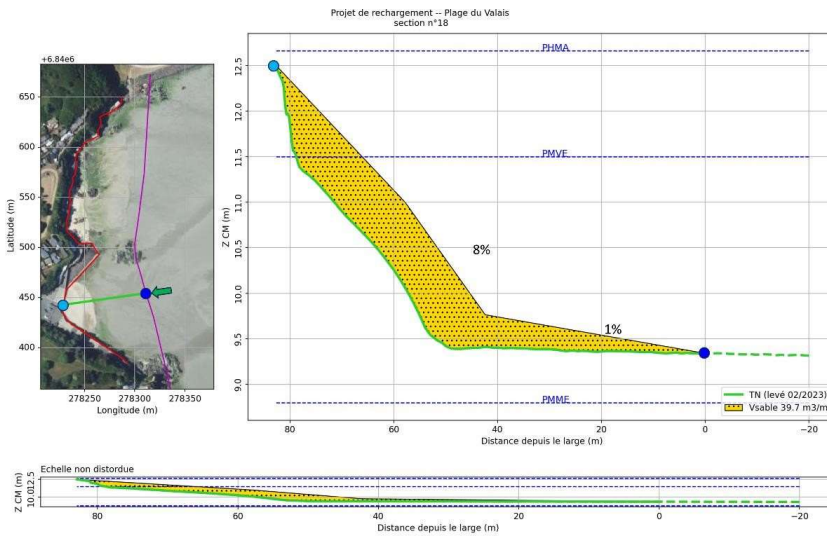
Rechargement de 12 000 m<sup>3</sup> : exemple de coupe-type (en échelles distordue et non-distordue) pour la section n°18. Rechargement en jaune, TN en vert. Localisation du profil sur la carte de gauche.
